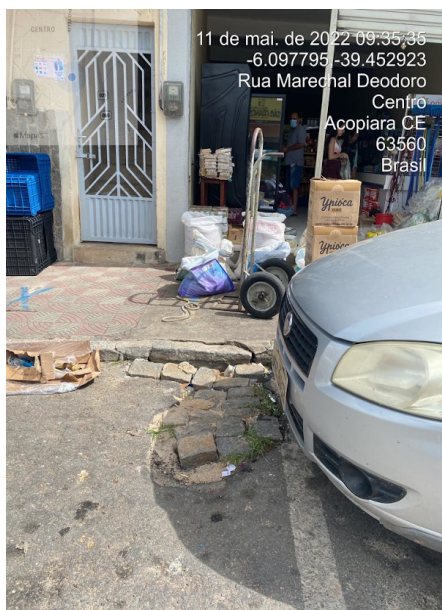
Rua Marechal Deodoro, Centro: pavimento sem recuperação.
